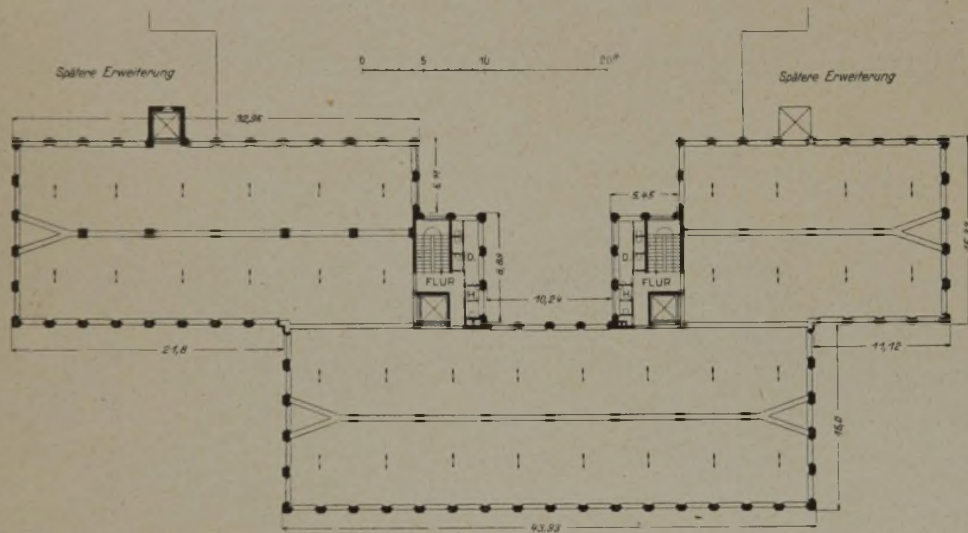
Grundriß des 2. und 3. Obergeschosses. II. Baustadium.
